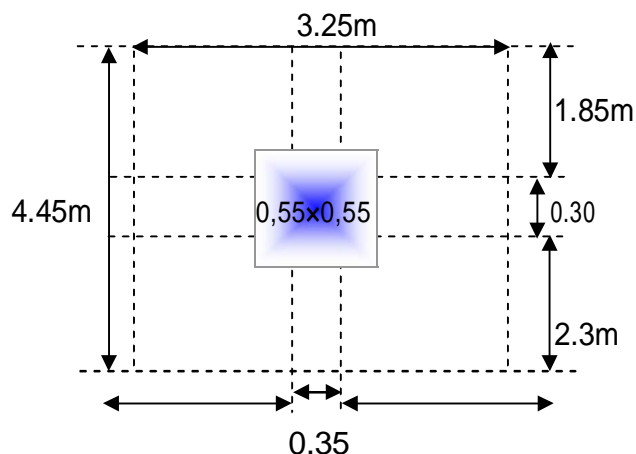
Coupe transversale d'un poteau du R.D.C.
